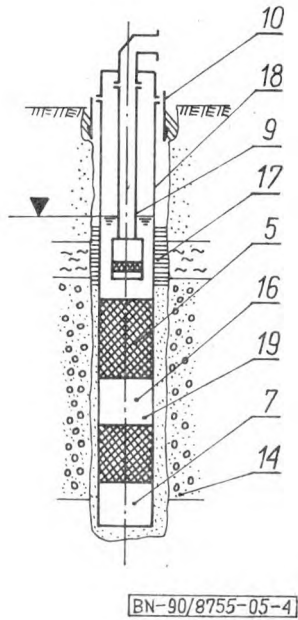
Przykładowa konstrukcja studni wiercanej metodą obrotową płuczka (airlift) i z traconą kolumną filtrową
